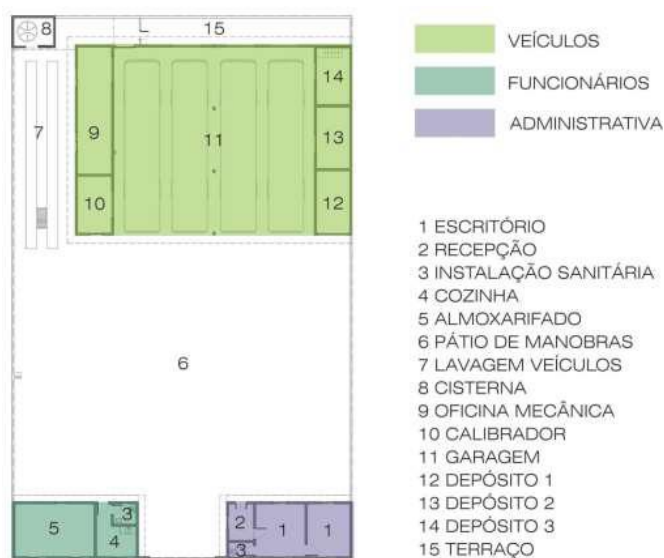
Planta de setorização da empresa avaliada neste estudo
